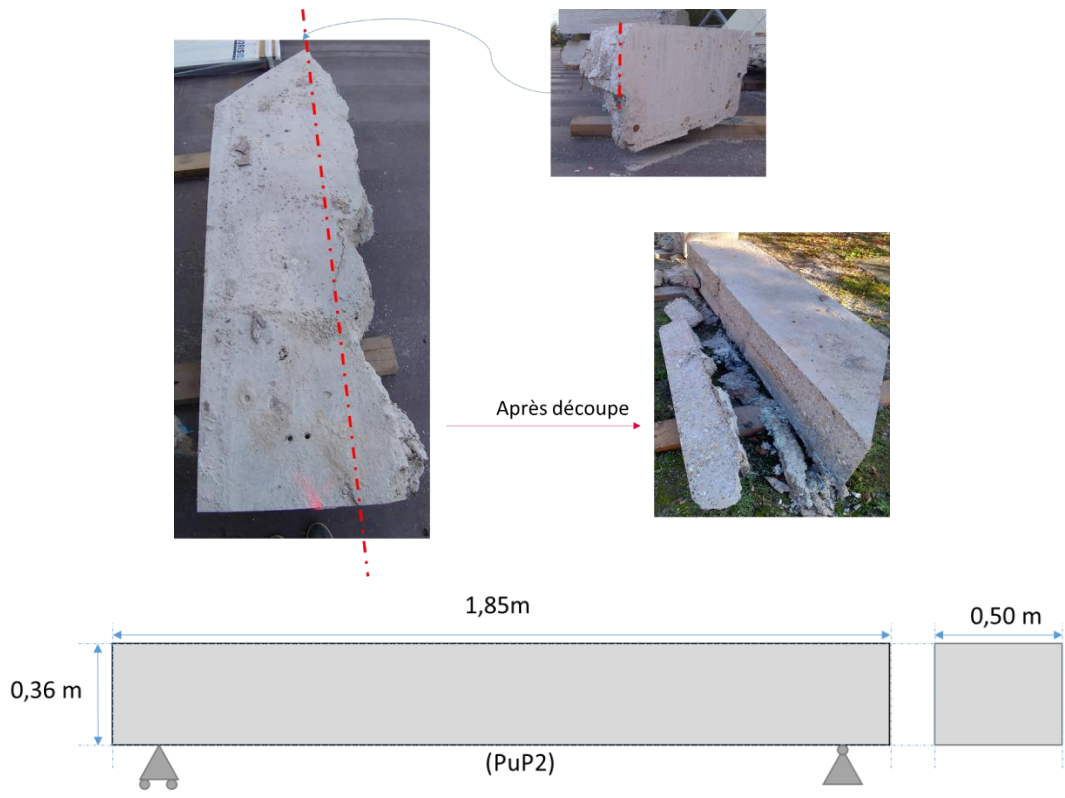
Présentation de la poutre PuP2 (chantier de Paris)
